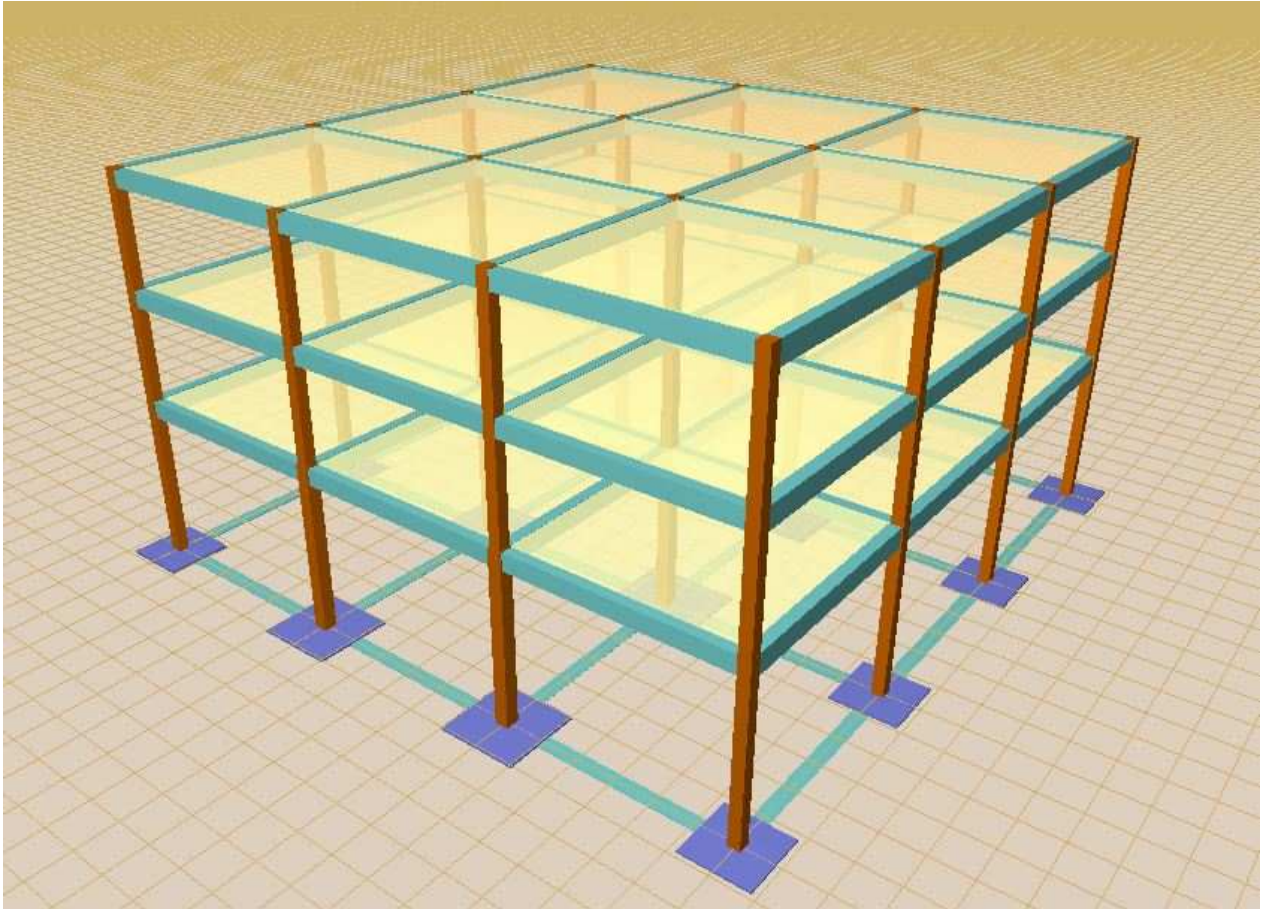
Vista 3D. Edificio de 3 plantas.
